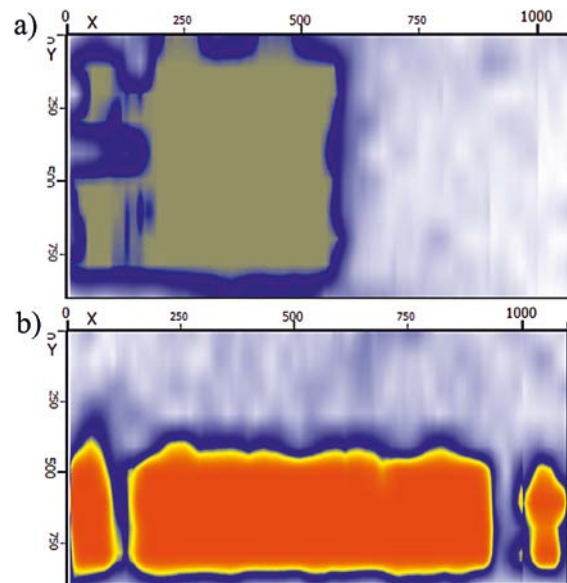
Element betonowy P19 – widok od tyłu – pomiar wysokości
